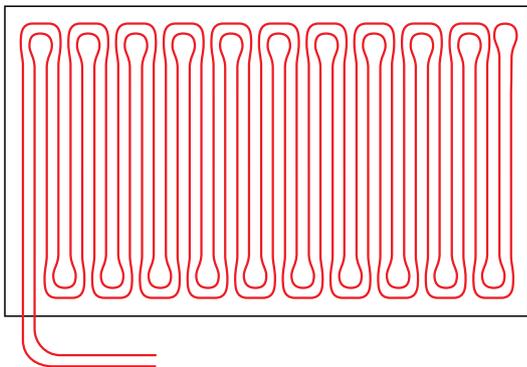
Kühldeckenelement in Trockenbauweise
